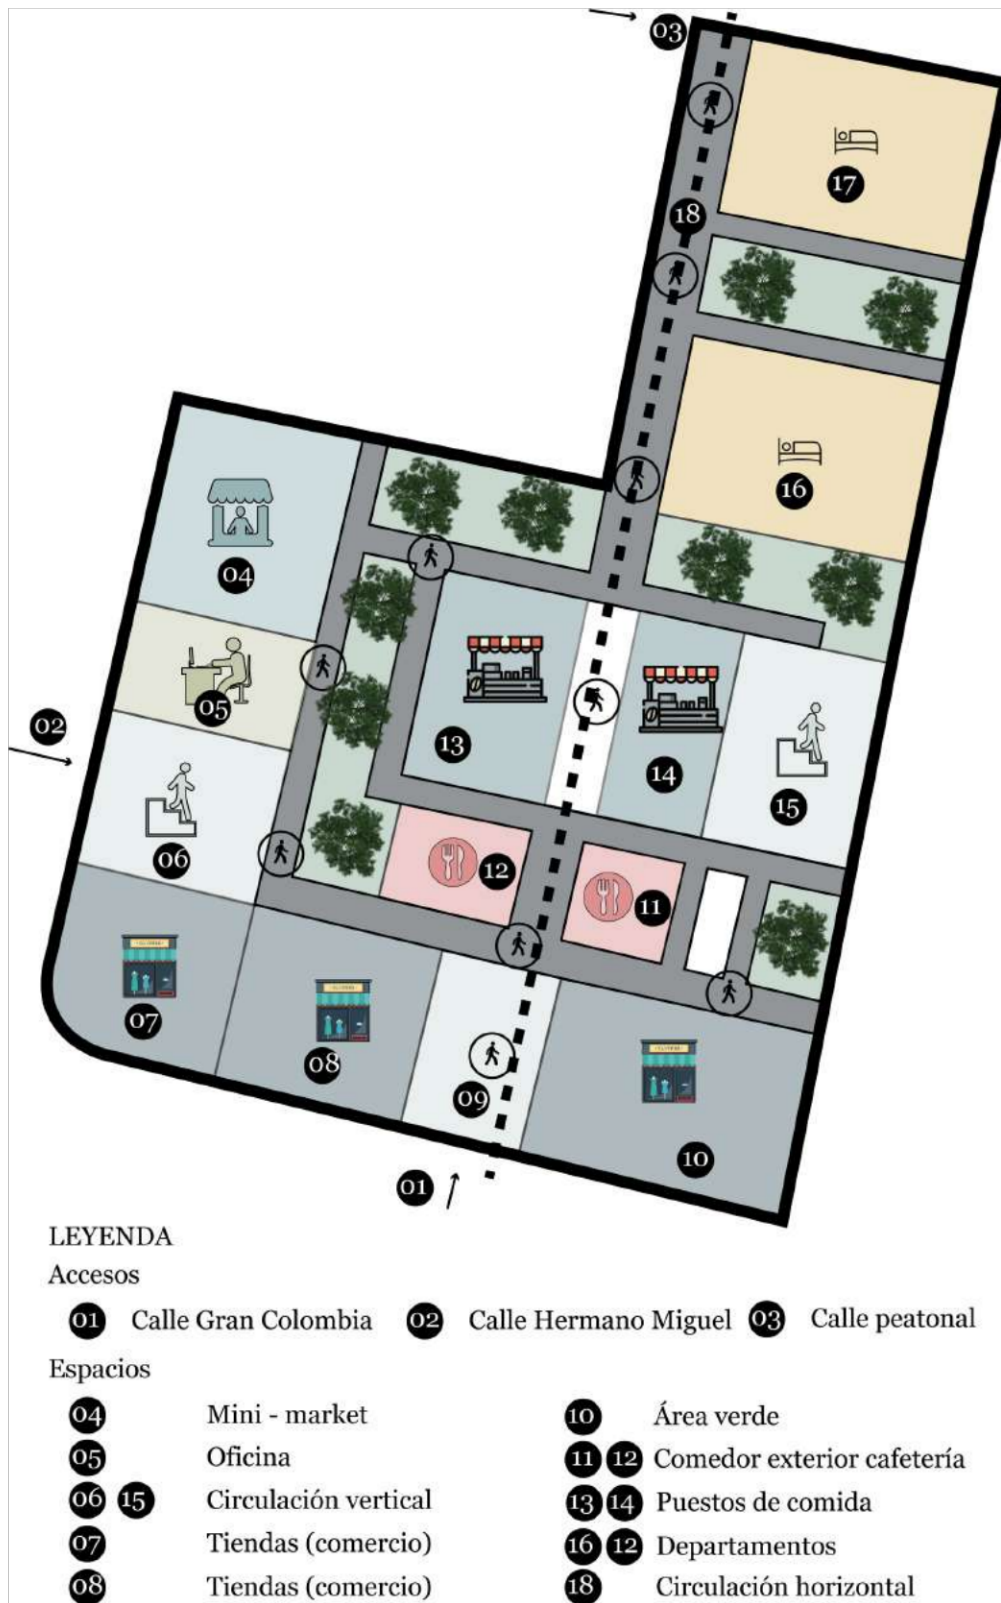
Zonificación planta baja. // Fuente: propio // Elaborado: propio
